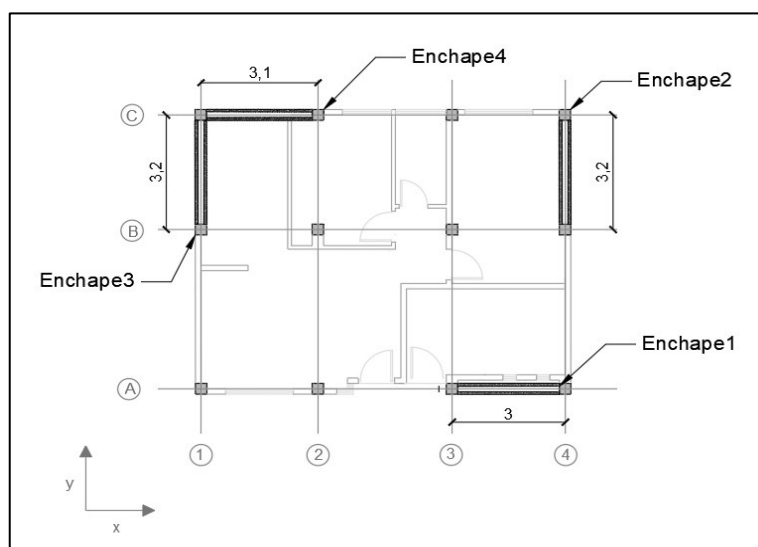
Esquema de ubicación de paredes enchapadas en planta de modelo enchape (E1-Propuesta 1).
